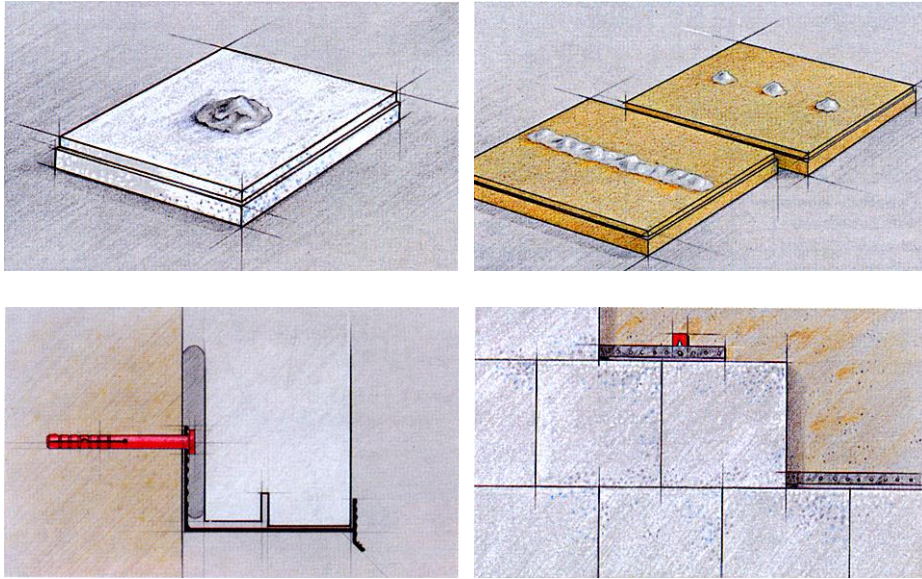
Наклейка и крепление теплоизоляционных плит планками.
